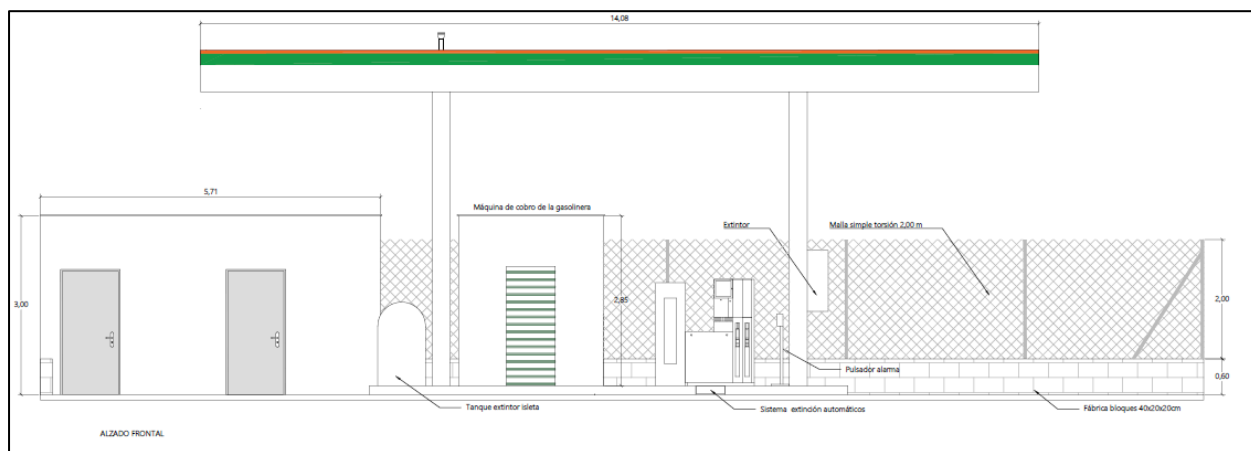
Esquema proyectado de la instalación. Fuente: Proyecto Constructivo.
